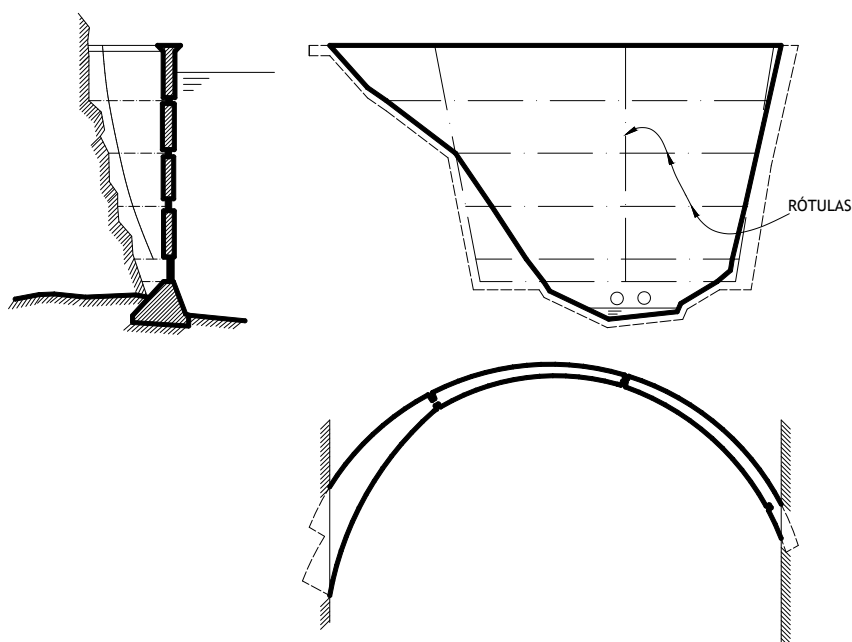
(a), (b) e (c) - Barragem de Llauset (esquemática): corte em alçado lateral esquerdo (a), alçado principal de jusante (b) e planta (c) (adaptado de [38]).
